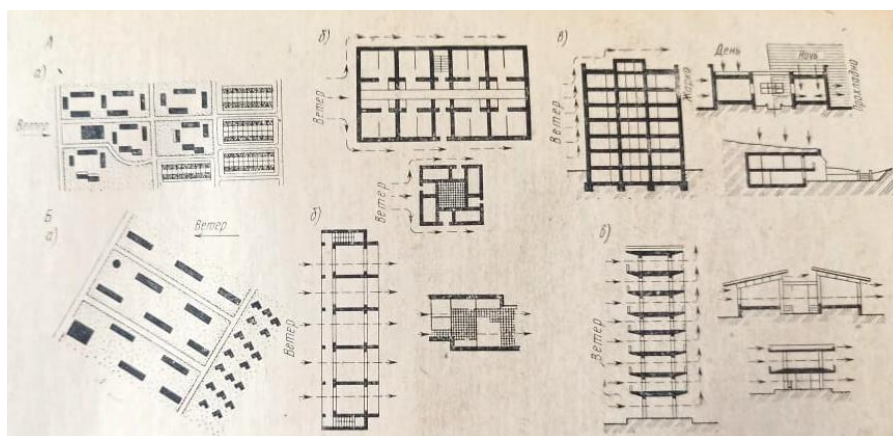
Приемы проектирования в условиях жаркого климата: А – сухого; а – замкнутая, плотная застройка; б – планировочные решения зданий; в – защита помещений от внешних тепловых воздействий (большая ширина здания, заглубление его) днем и тепловыделения через ограждения ночью; Б – влажного; а – застройка с учетом проветривания; б – планировочные решения зданий; в – удаление тепла путем проветривания покрытий и помещений.
